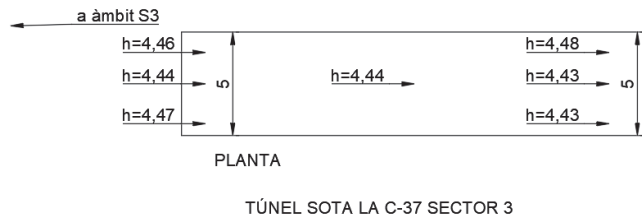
Dimensions del túnel del sector 3 sota la C-37.
